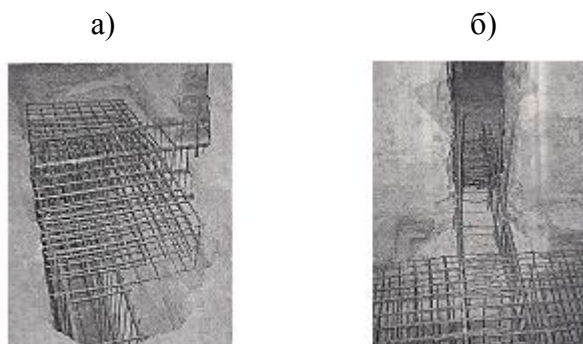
Сопряжение монолитных колонн с существующими фундаментами наружных (а) и внутренних (б) стен
